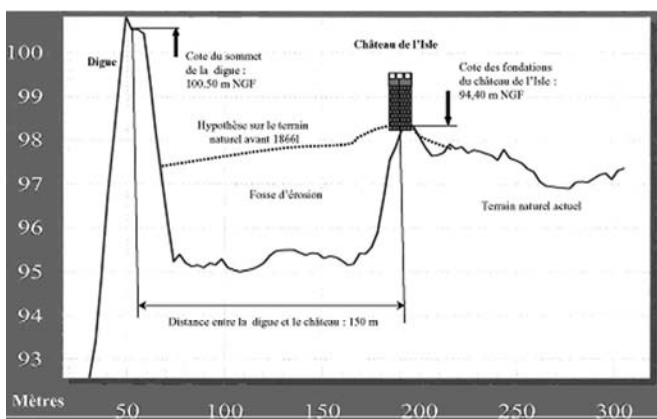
PROFIL EN TRAVERS DE LA LEVÉE ET DU SITE DU CHÂTEAU DE L'ISLE.
